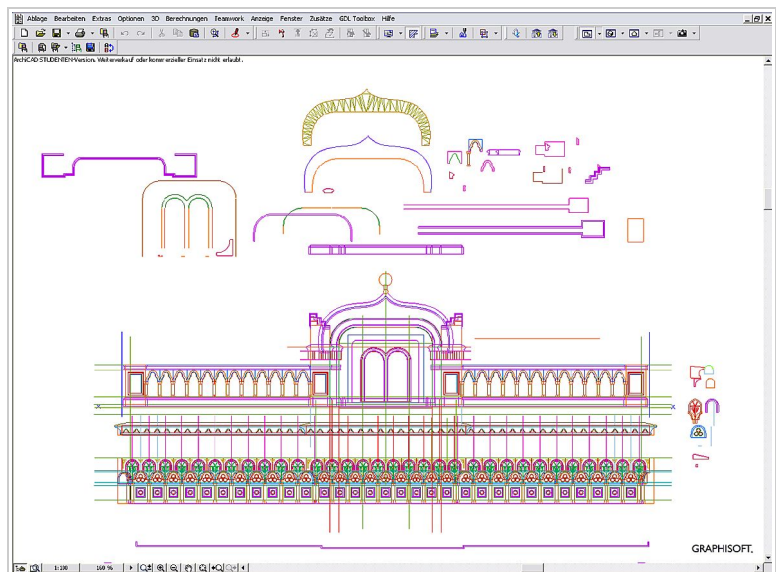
Der Bauplatz der Fassadenattika im Grundriss. Bei dieser hochkomplexen 3D-Struktur war eine permanente Kontrolle aller Konstruktionsschritte im 3D-Fenster besonders wichtig.
